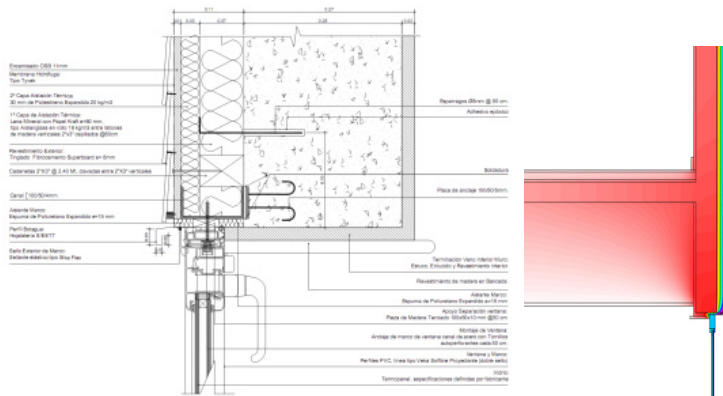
Detalle ruptura de puente térmico de muro exterior identificado como Tipo 1
